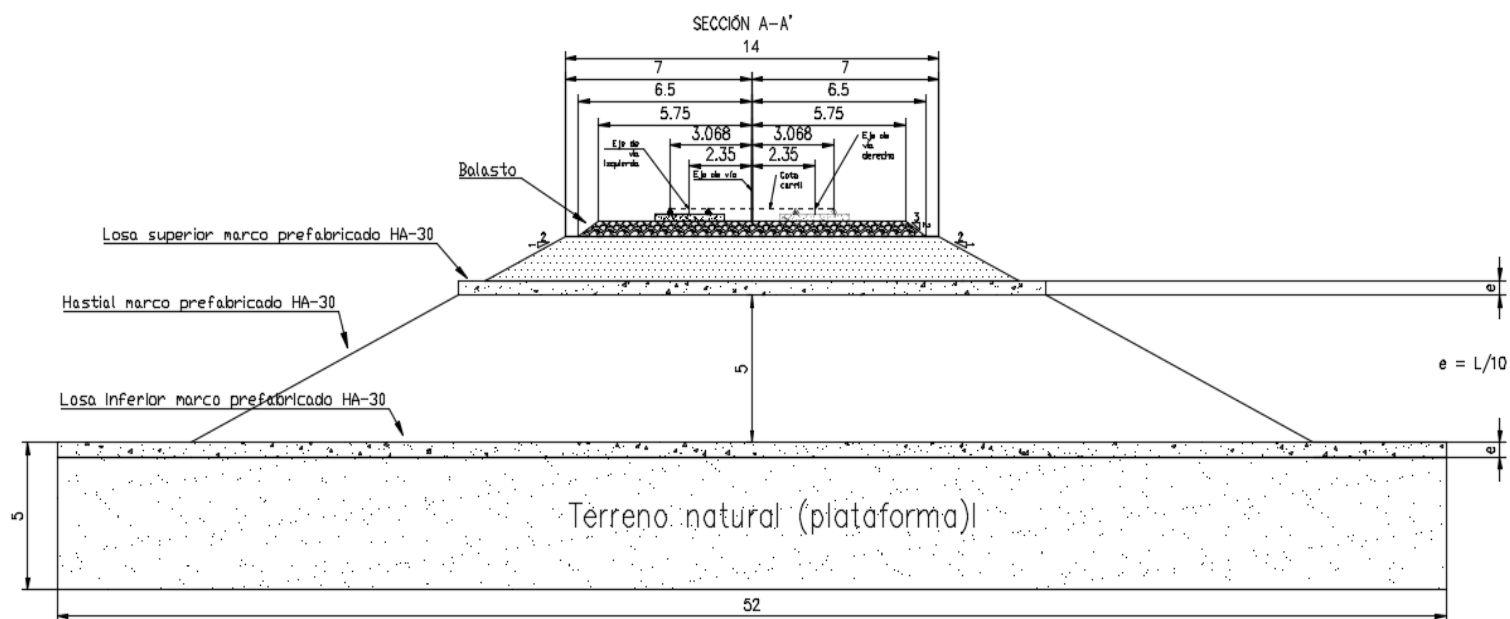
Sección A-A' (indicado en planta, figura 3.6).
